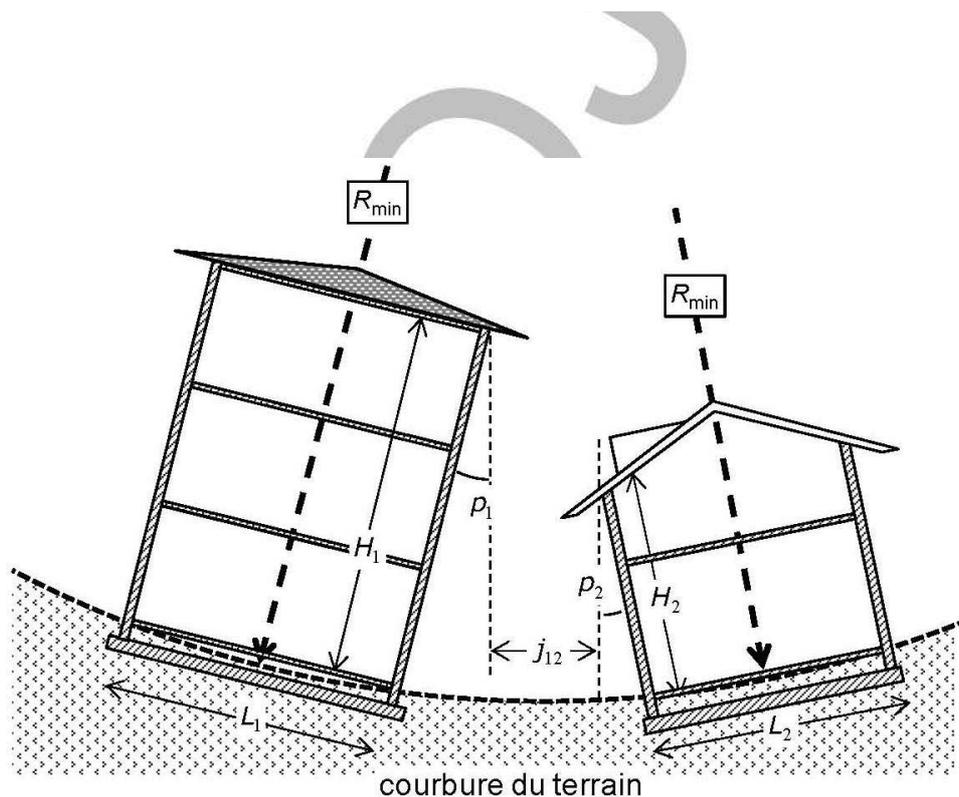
Largeur du joint vertical d'affaissement due à la courbure du terrain
